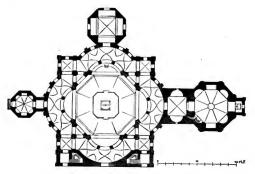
S. Lorenzo in Mailand. Grundriss.
